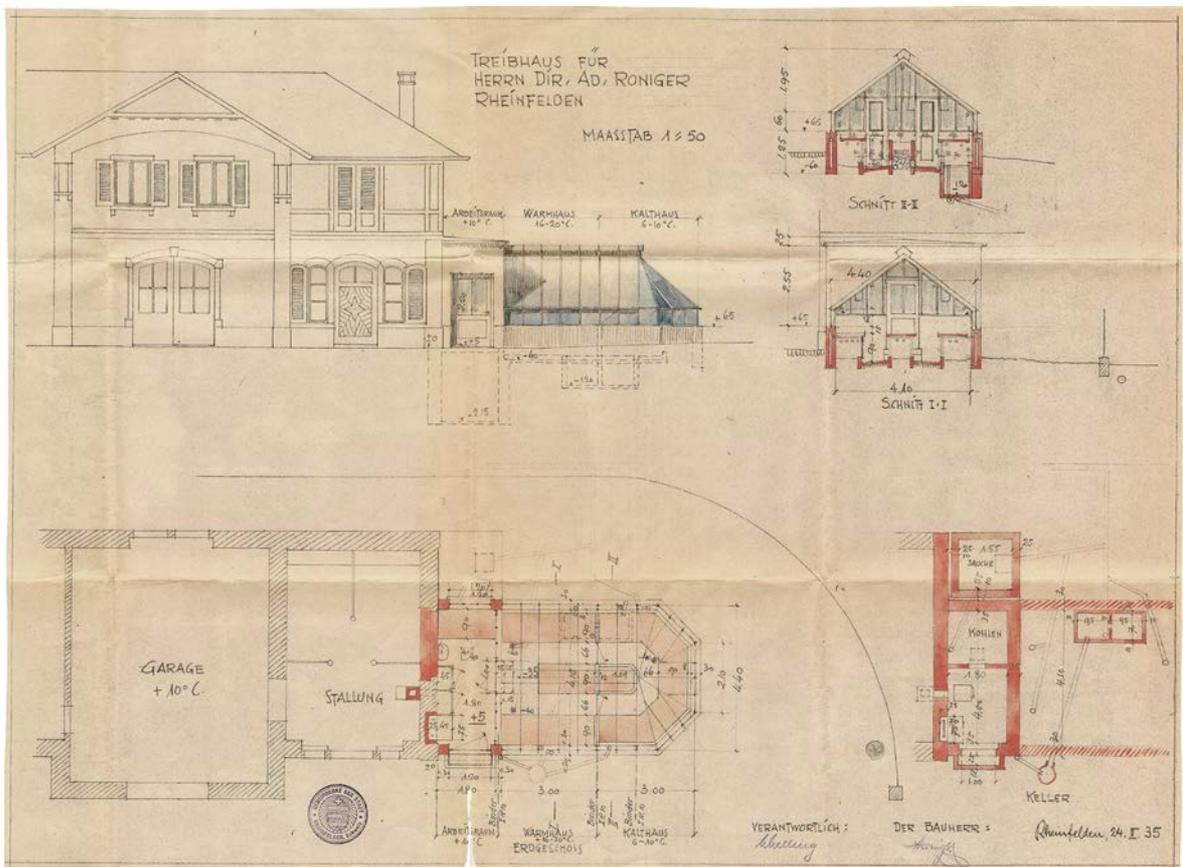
Baueingabeplan von 1935 für das Treibhaus. Quelle: Stadtbauamt Baugesuchsakten.
